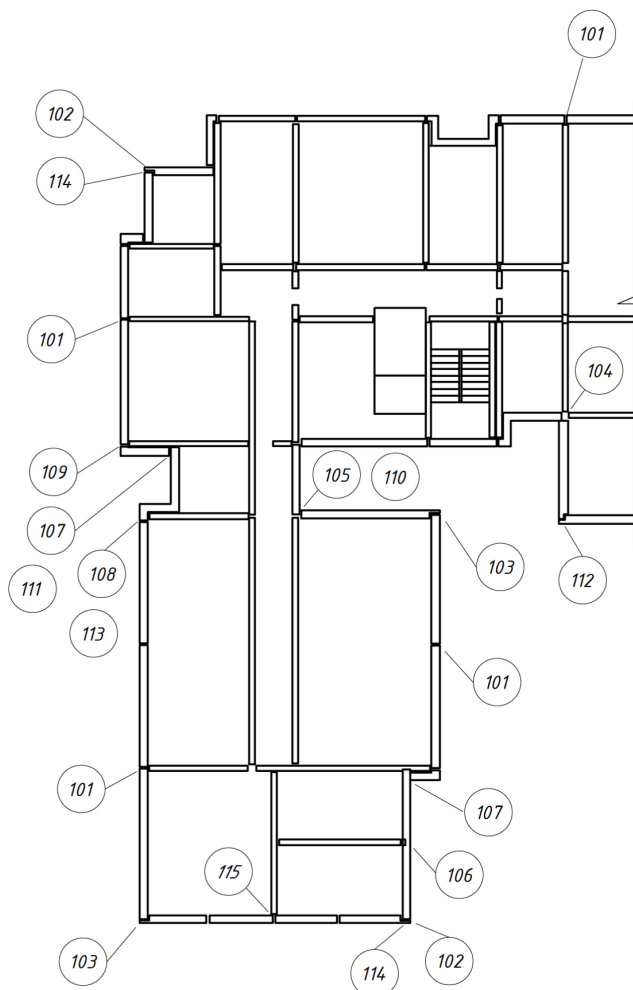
Маркировочная схема узлов сопряжения панелей наружных стен
